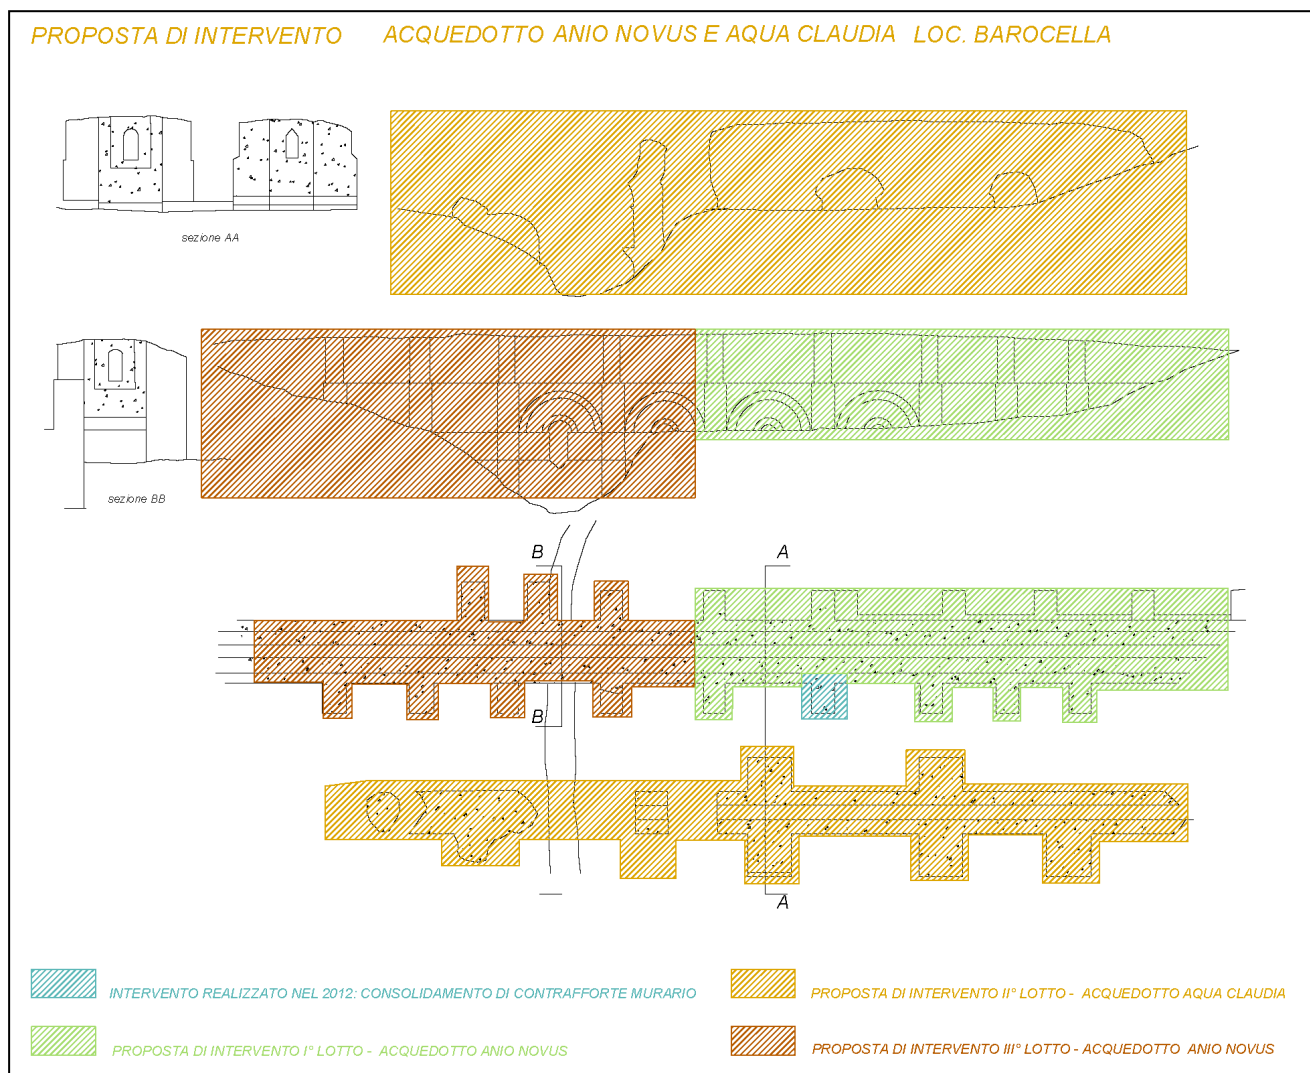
Ponte Diruto: Anio Novus, planimetria delle proposte progettuali d'intervento.
